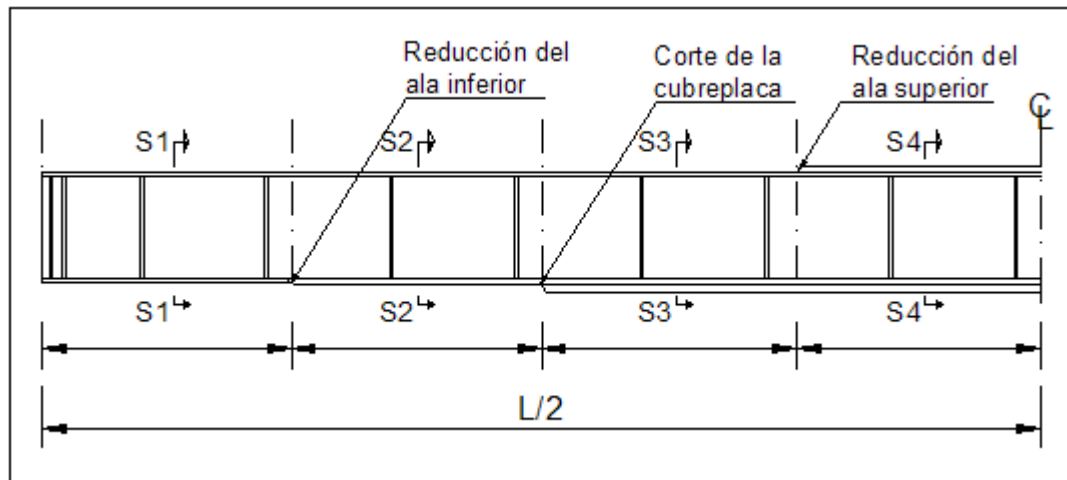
Seccionamiento de la viga y puntos donde cambia la sección de acero.
